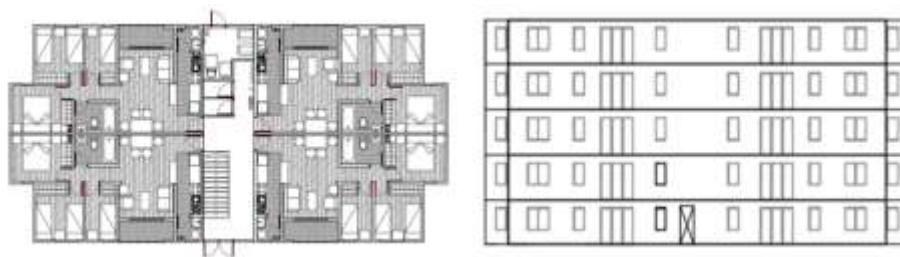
Vista en planta y fachada de la configuración arquitectónica tipo de 5 pisos
